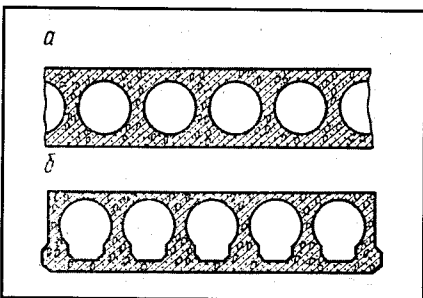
Збірні залізобетонні пустотілі настили з круглими (а) і з вертикальними (б) пустотами.
